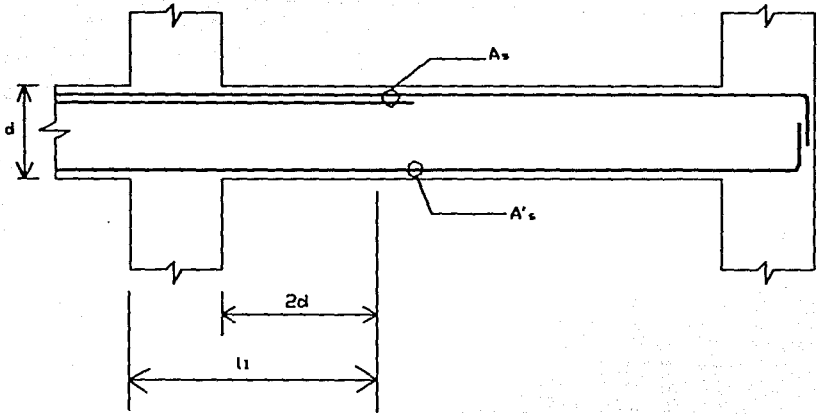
Requisitos para el refuerzo longitudinal en vigas de concreto (1.6)
